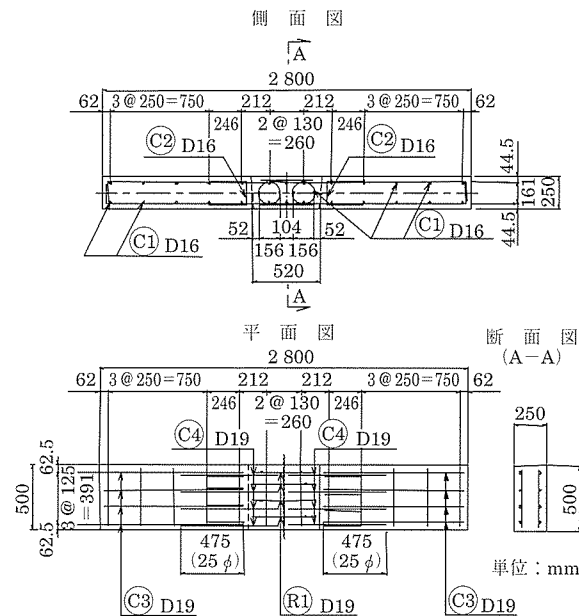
ダブルループ鉄筋継手の鉄筋配置図
